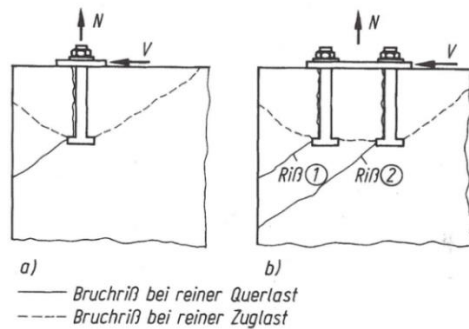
Schematische Darstellung von Bruchrissen bei Befestigungen am Bauteilrand unter Schrägzugbelastung Richtung Bauteilkante, Eligehausen/Mallée 2000, 131, zitiert nach Zhao/Eligehausen 1992 (nicht veröffentlicht)
